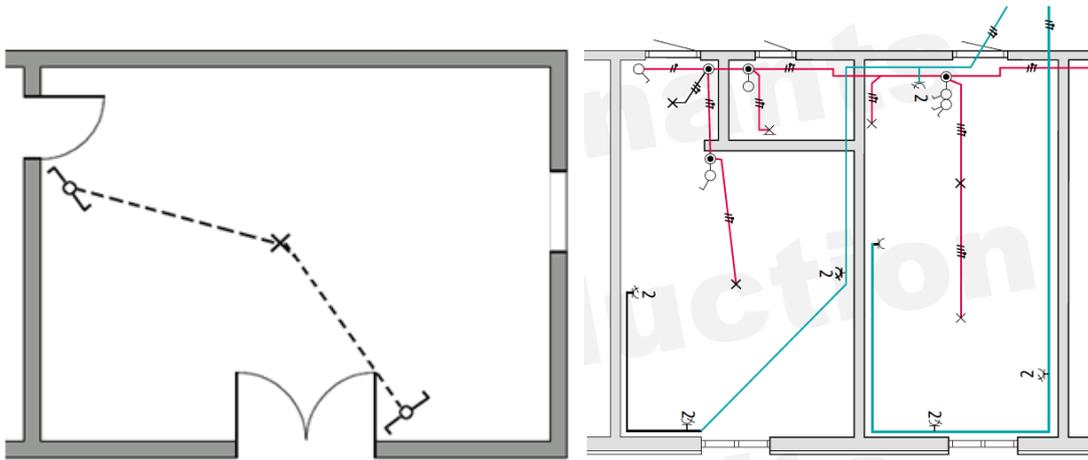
Schéma architectural d'une installation dans un bâtiment
